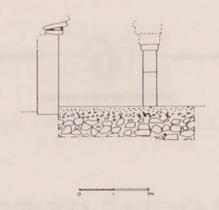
Xcalumkín (Campeche). Plano de las estructuras D4-8 sub y D4-8.
